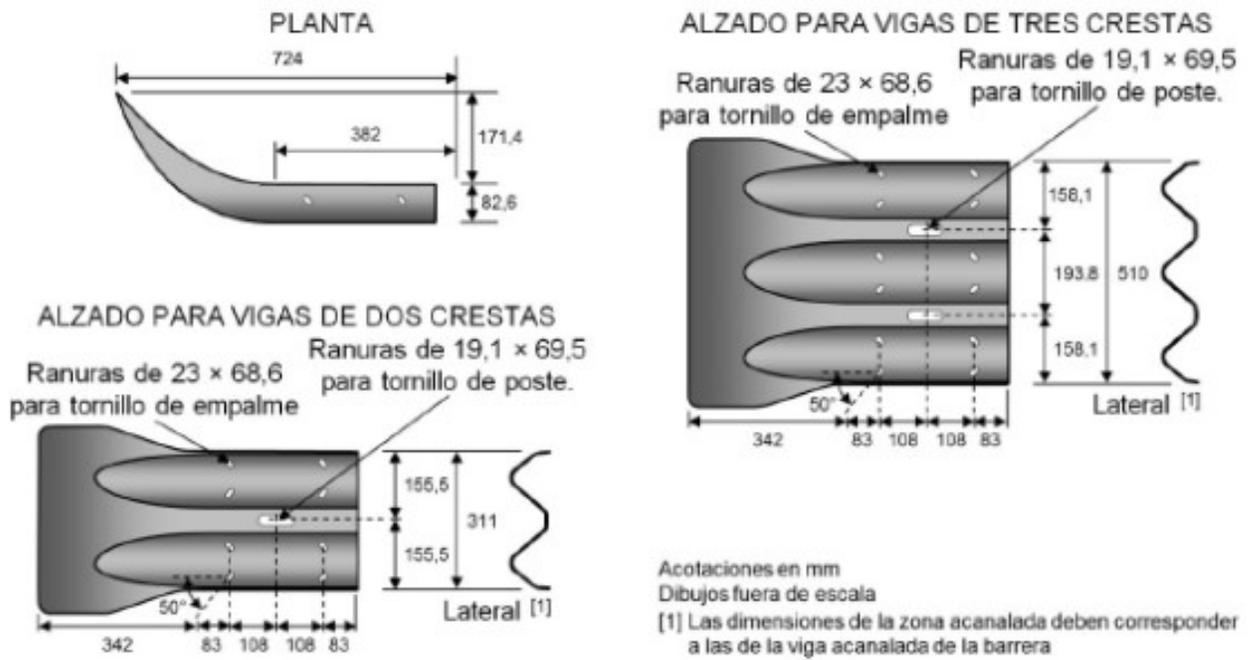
Secciones terminales sencillas para vigas acanaladas de dos y tres crestas (OD-4.4.2/S)
